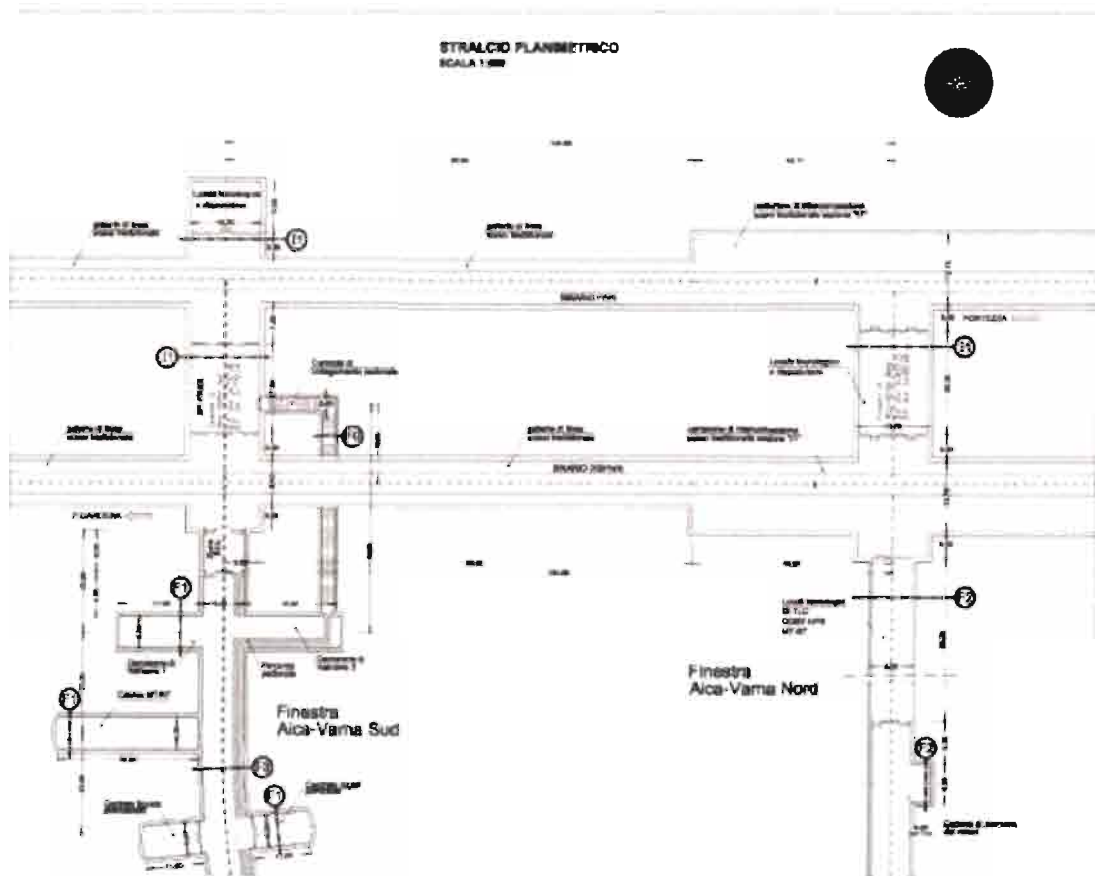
Auszug aus dem Lageplan des Einbindungsbereichs des Fensterstollens Aicha-Vahrn mit den Streckentunneln.
